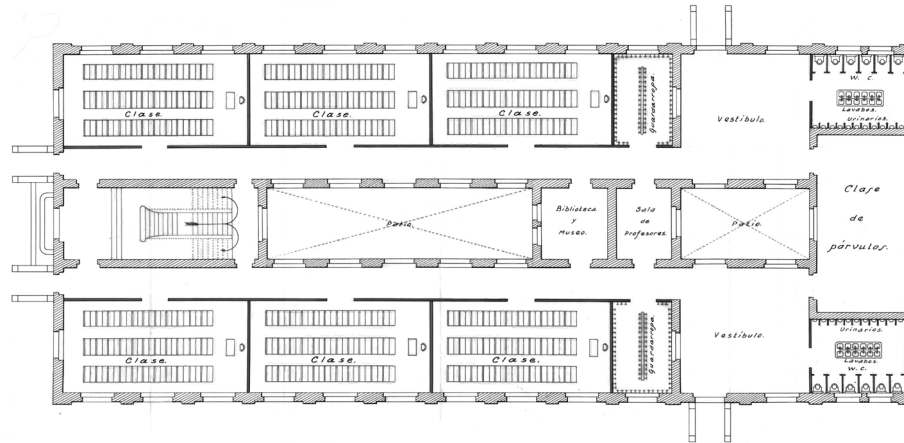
, Planta Baja. Proyecto 1933, Vicente Pascual
